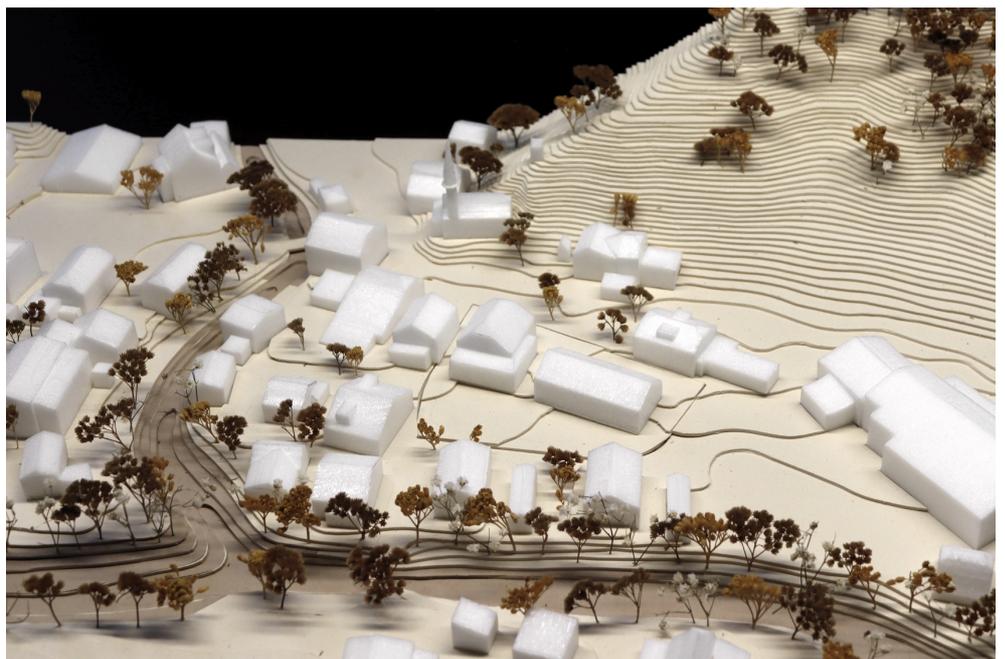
Bebauung mit einer Grossform [Dällenbach/Ewald Architekten AG]
